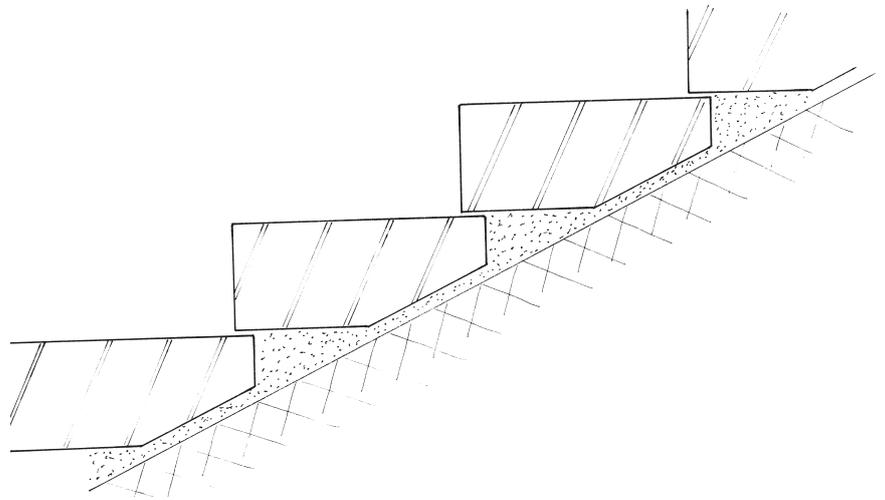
Trittplatten auf Betontreppe ohne Stirnplatten (Stirne Beton).
